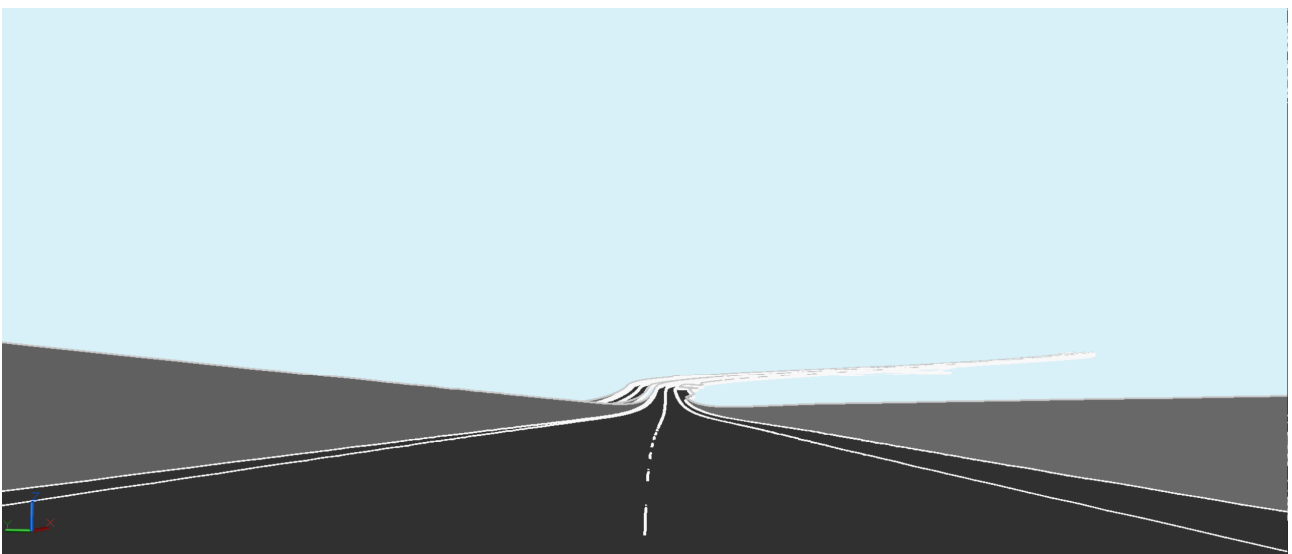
Visione prospettica in uscita alla curva planimetrica 10 (Carr. GR-FA)
